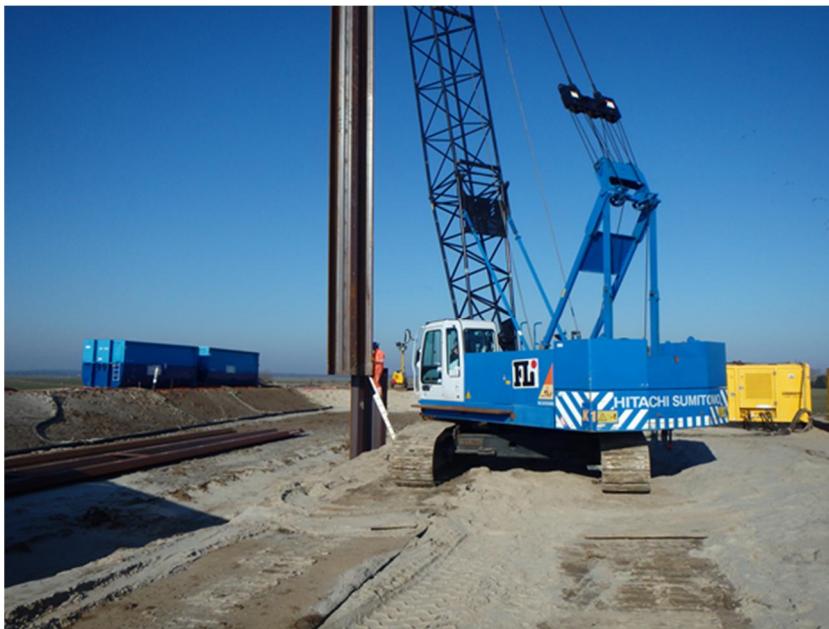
Plaatsen damwandplank in hulpconstructie in zandkern tbv erop zetten trilblok
